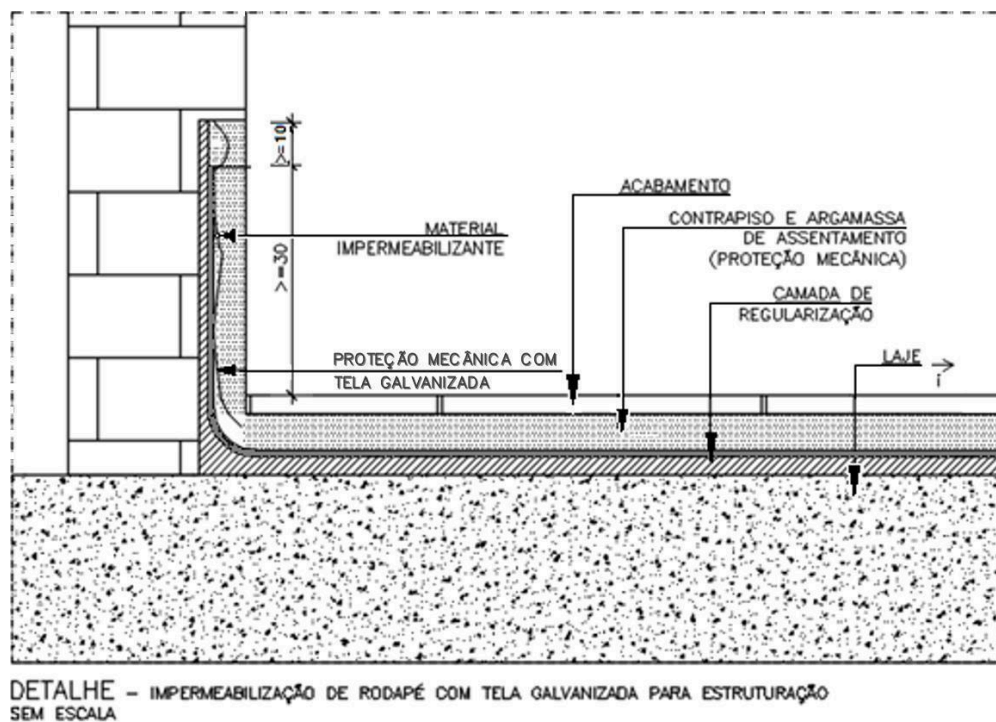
Detalhe da impermeabilização de rodapés com tela de reforço.
